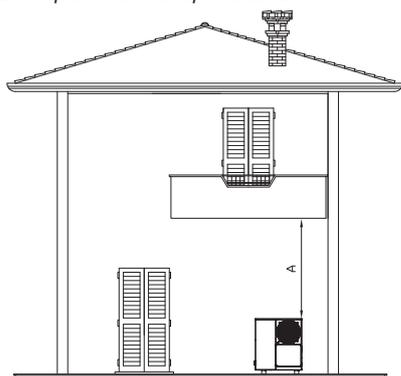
Distanze minime di rispetto K18 Hybrigas
